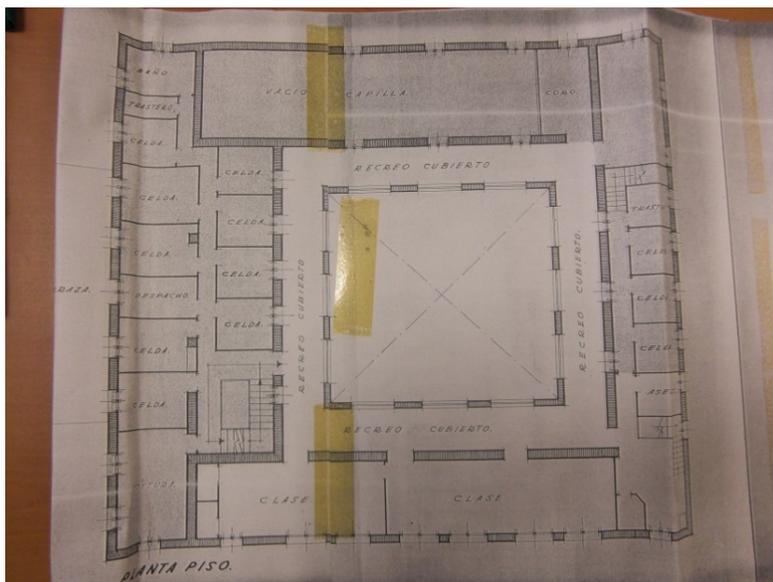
Imagen del plano original de planta primera del Convento de las Capuchinas. 1.950. Archivo Municipal.
